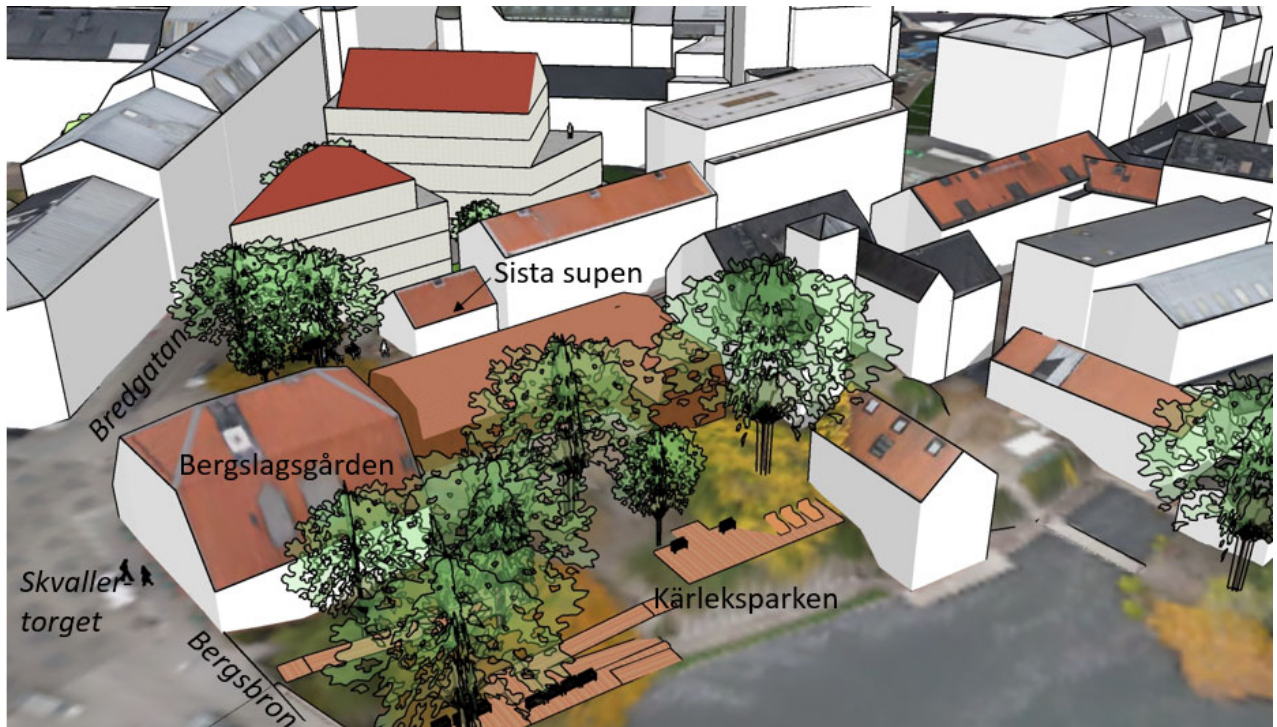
Bilden ovan visar ett utsnitt från samrådsförslaget till detaljplanen för fastigheterna Mjölneren 14 och Mjölneren 15 samt Bergsbron 7.
